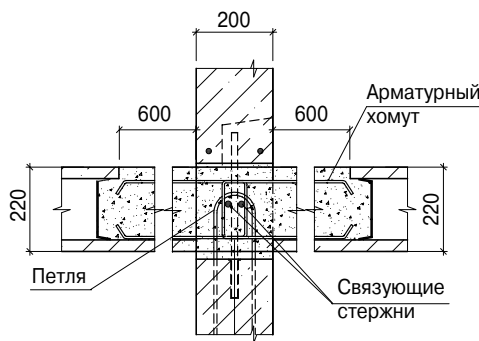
Пример соединения типовых плит перекрытия с панелями внутренних стен
